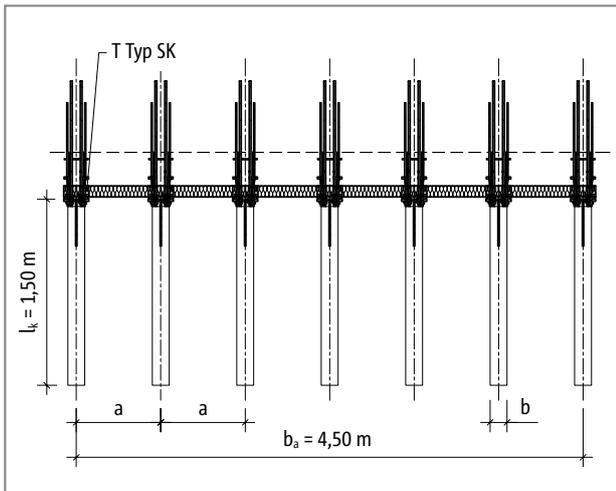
Schöck Isokorb® T Typ SK mit Stahlschwert: Grundriss
